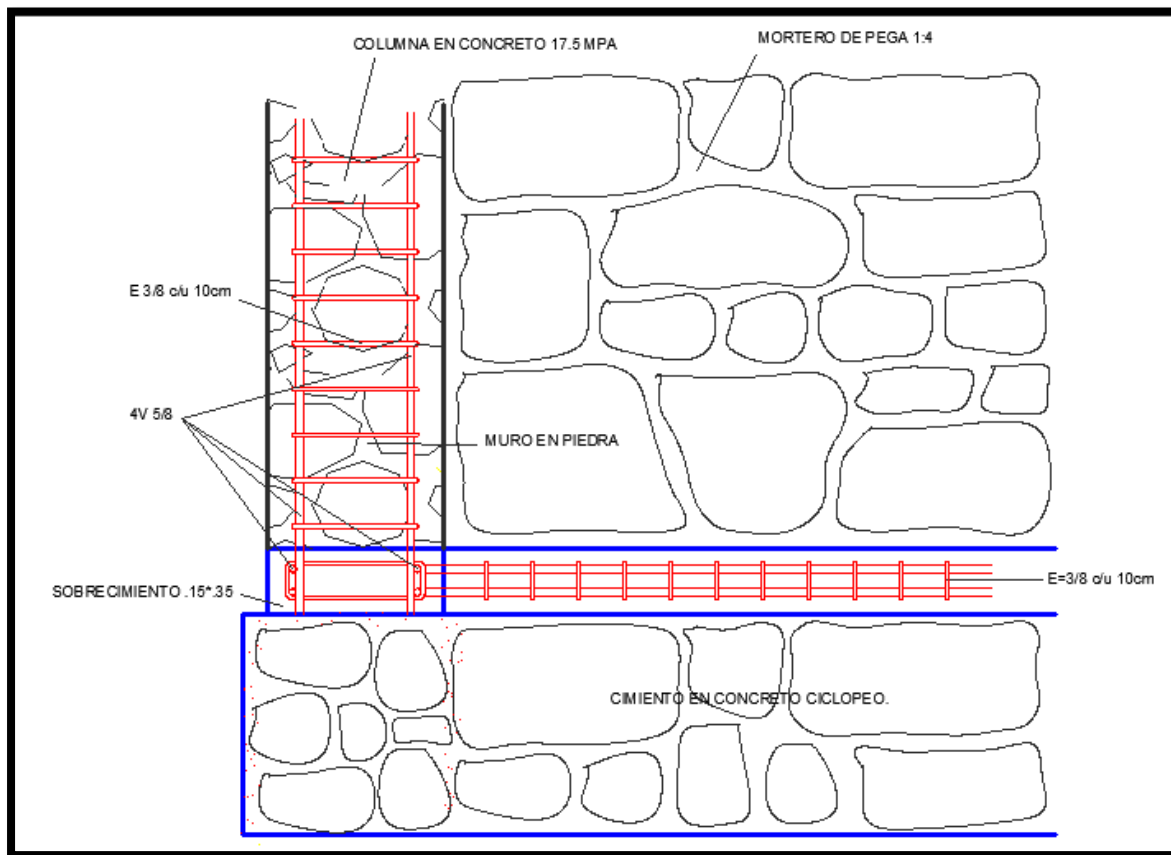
Detalle confinamiento y amarre sobrecimiento. Fuente: Propia
